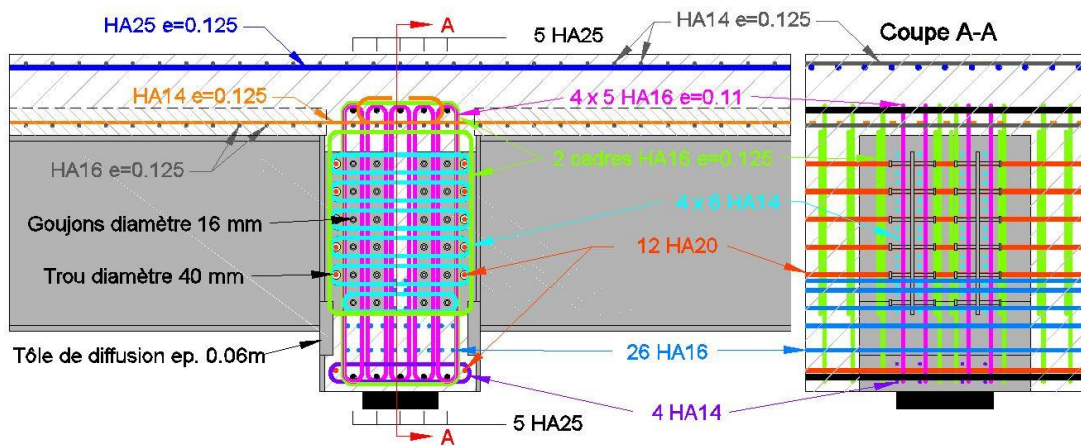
Principe de ferrailage du hourdis et des entretoises sur piles
